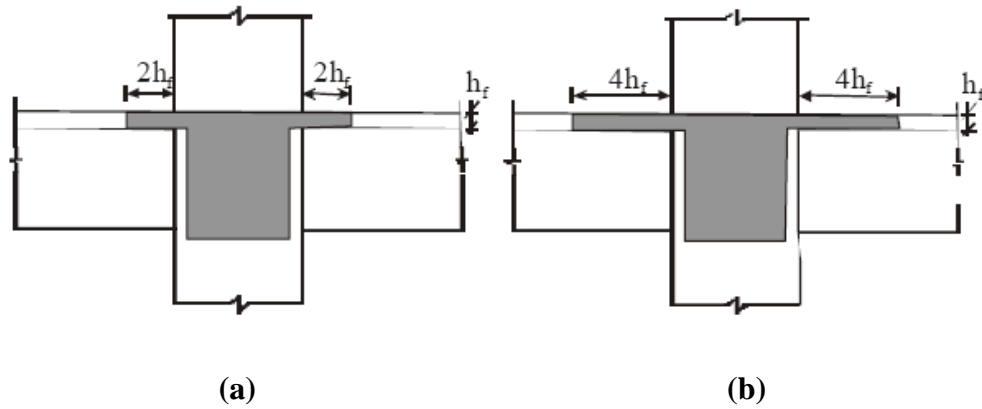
Anchos efectivos para vigas: a) exteriores; b) interiores. (Eurocode 8).
